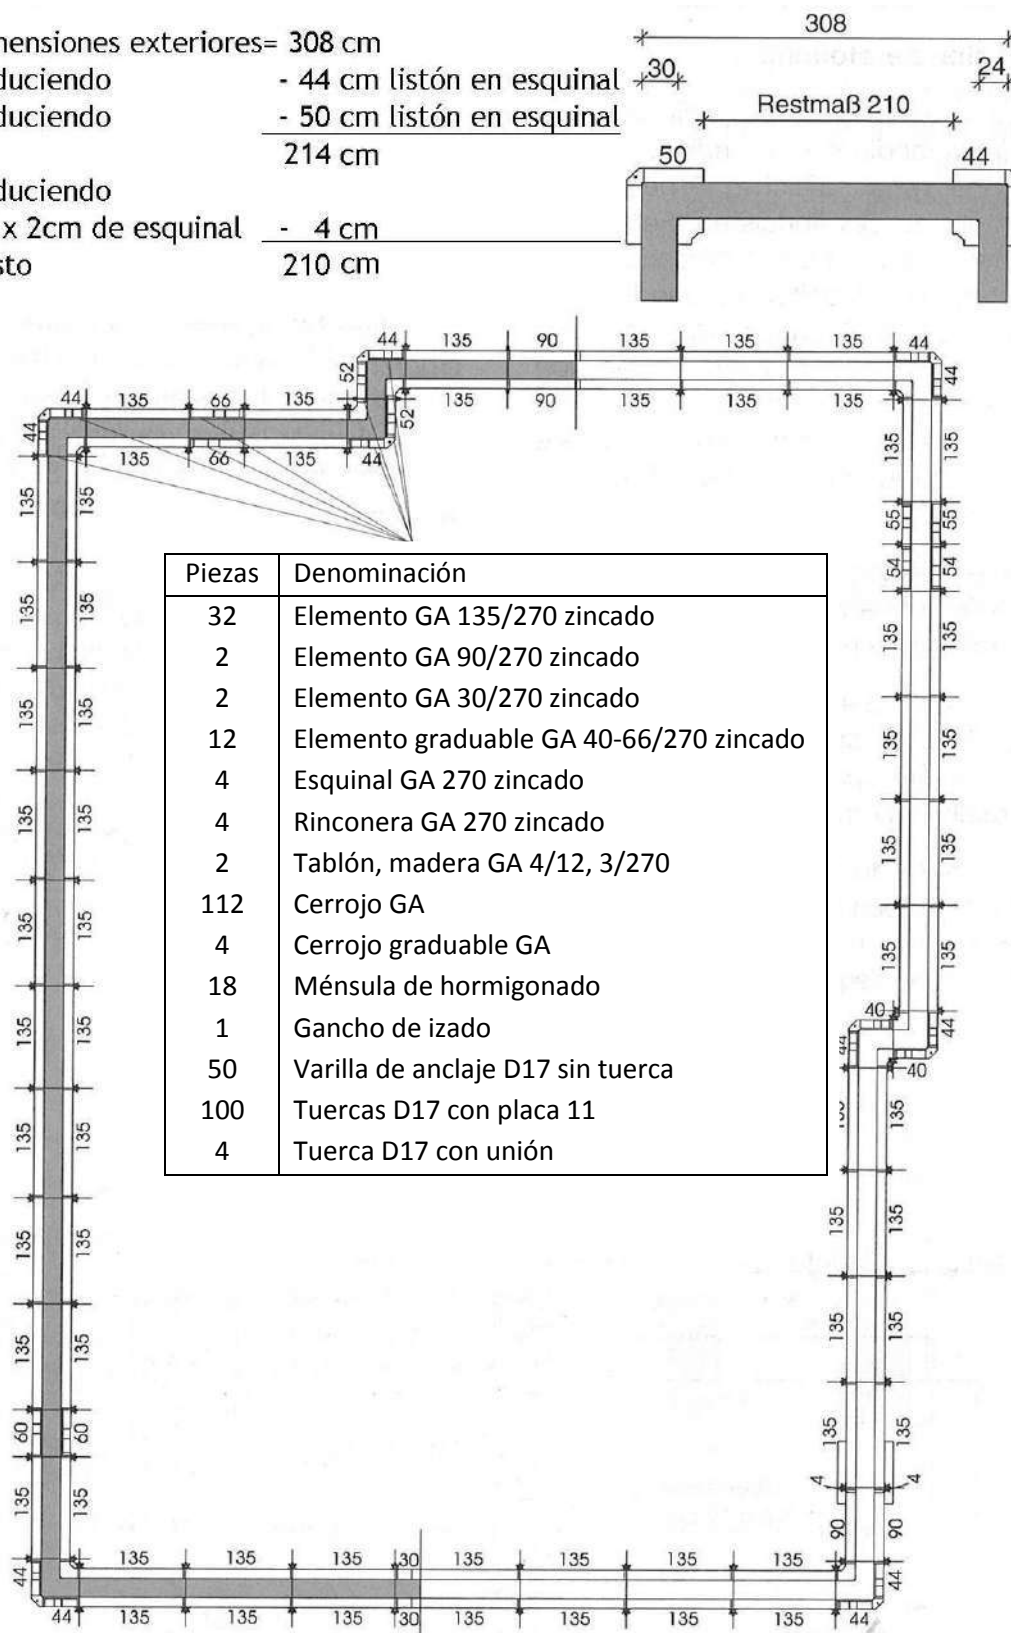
Plano de encofrado. Ejemplo de oferta tipo.
